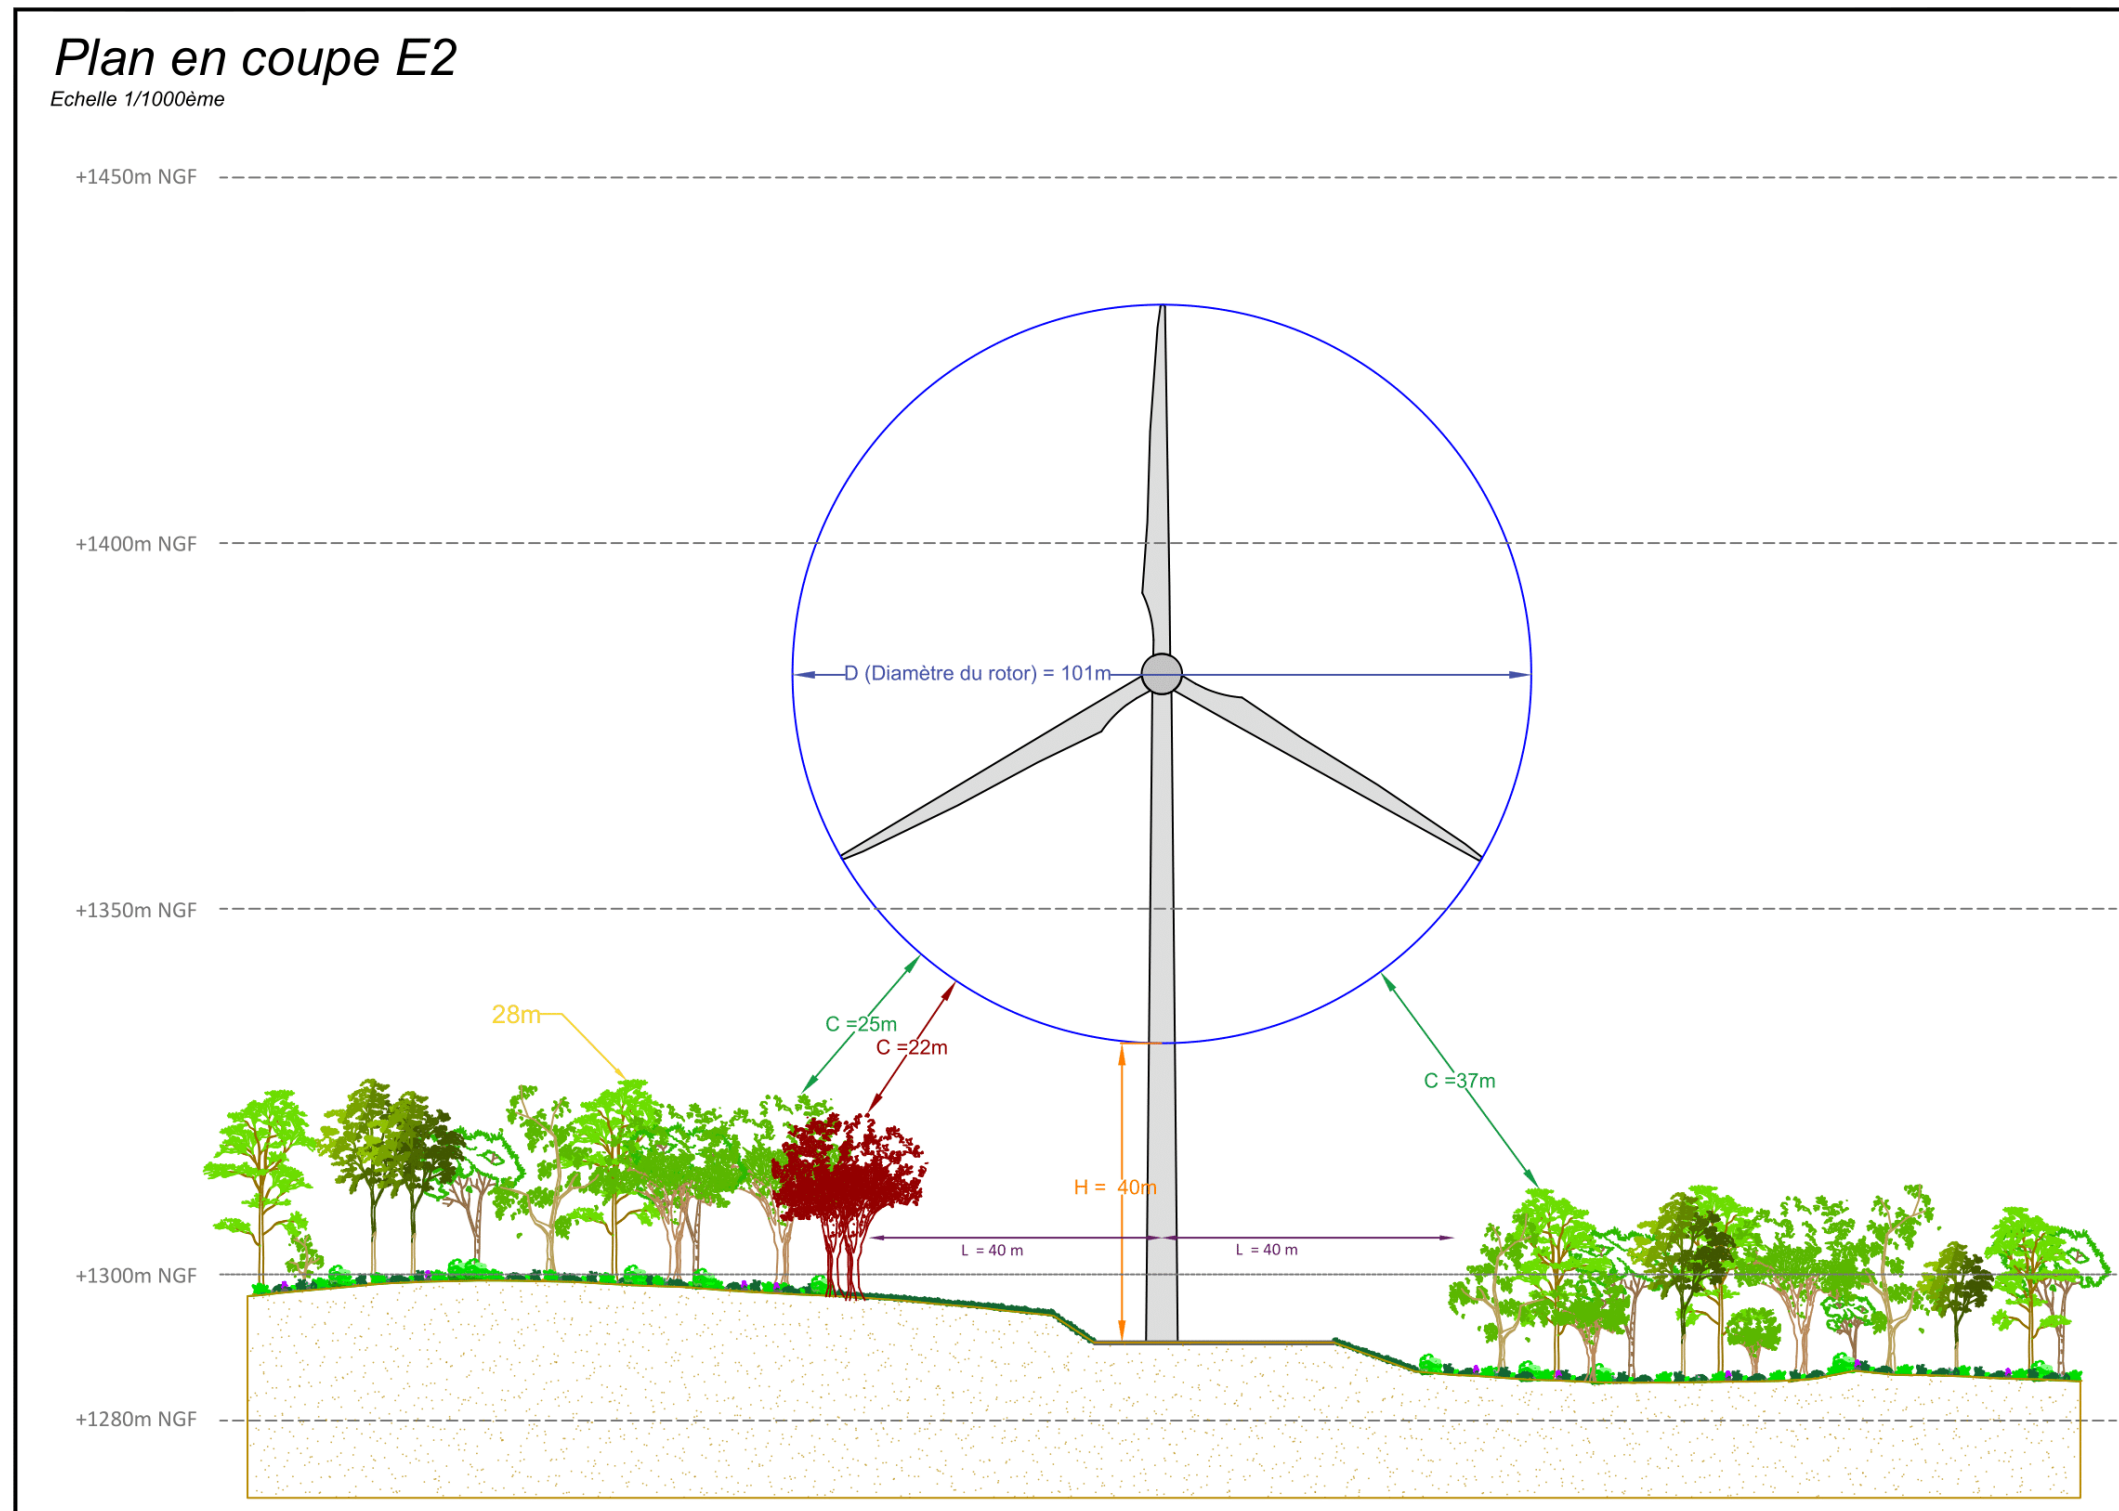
Plan de coupe et distance aux lisières (éolienne E2)
